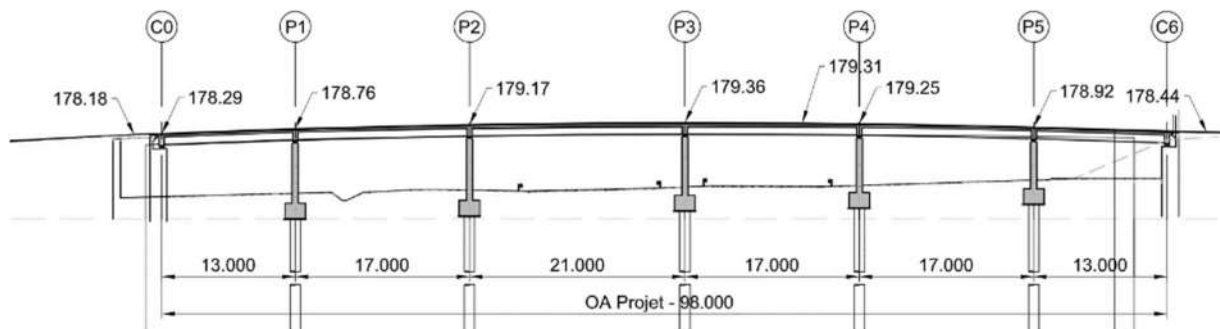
OA RN10 – Élévation longitudinale de l'ouvrage à créer
